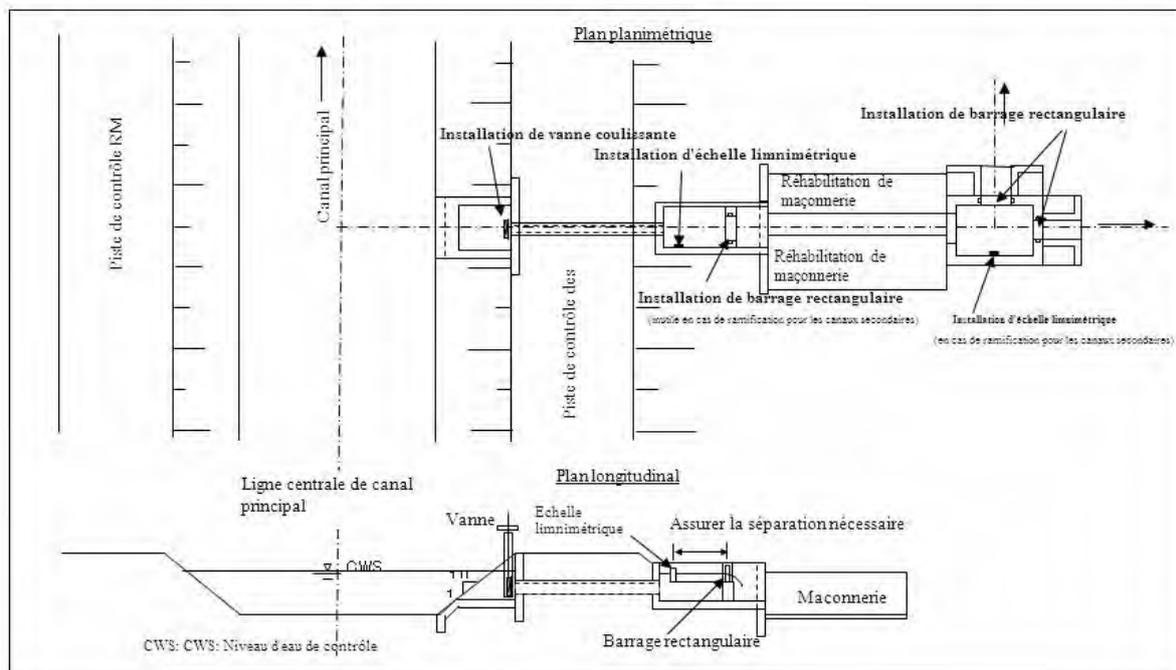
Plan de base de la réhabilitation des ouvrages de dérivation pour les canaux principaux
